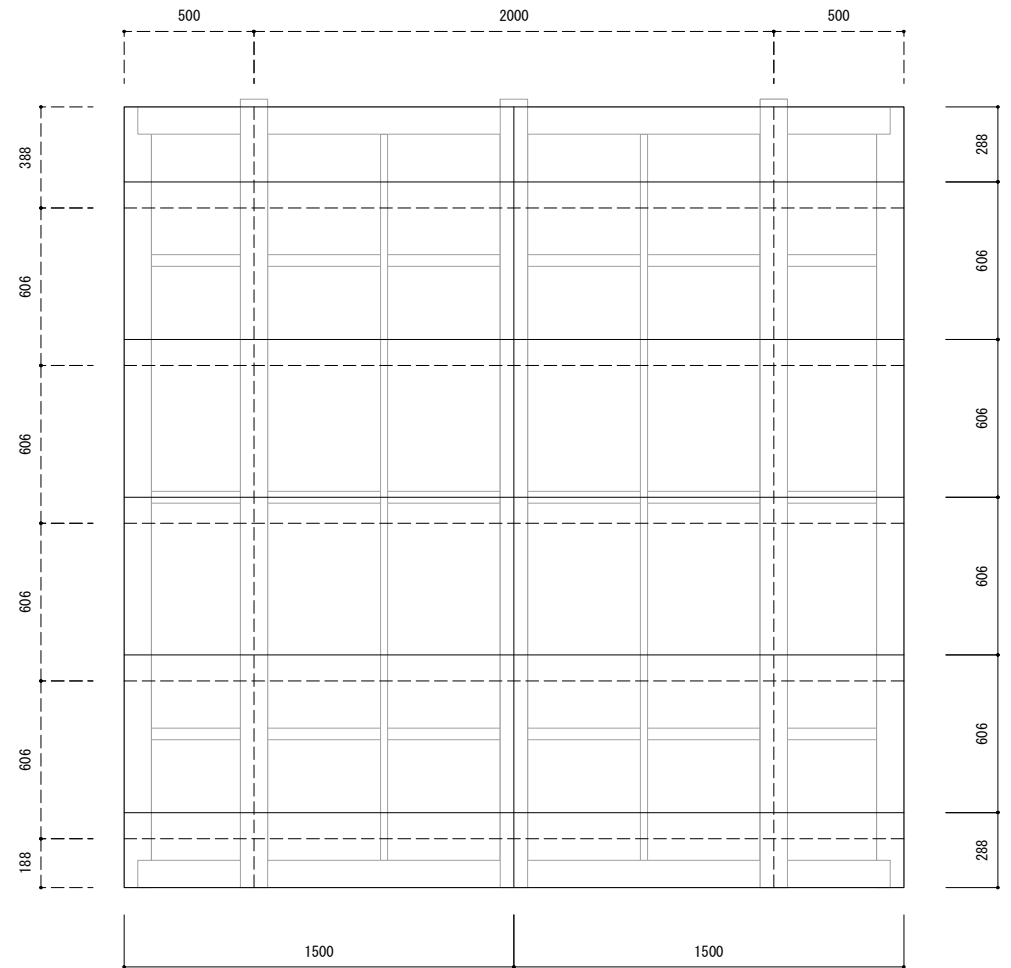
木造壁耐火試験用試験体 試験体図 (寸法 : mm)
